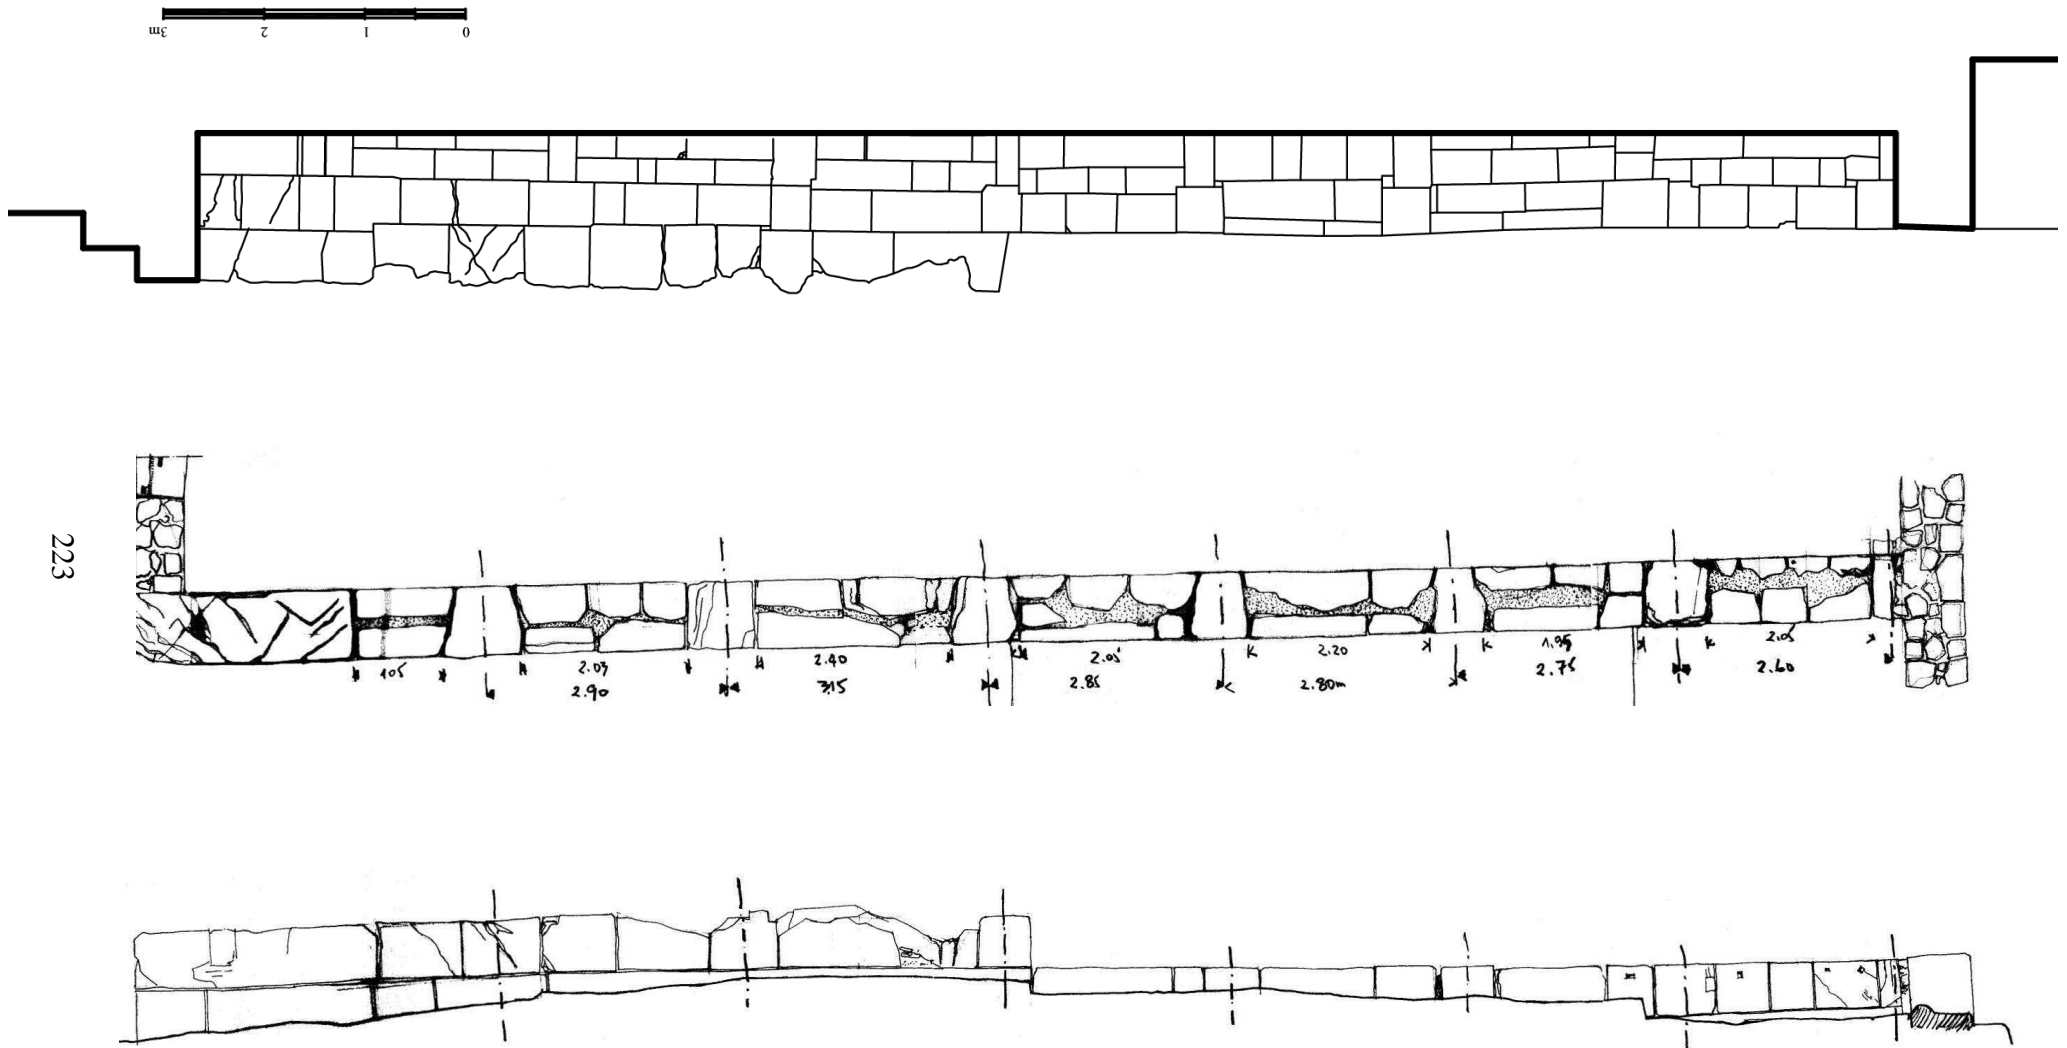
Relevé du mur (me₆) : au centre plan, en haut parement extérieur et en bas parement intérieur
